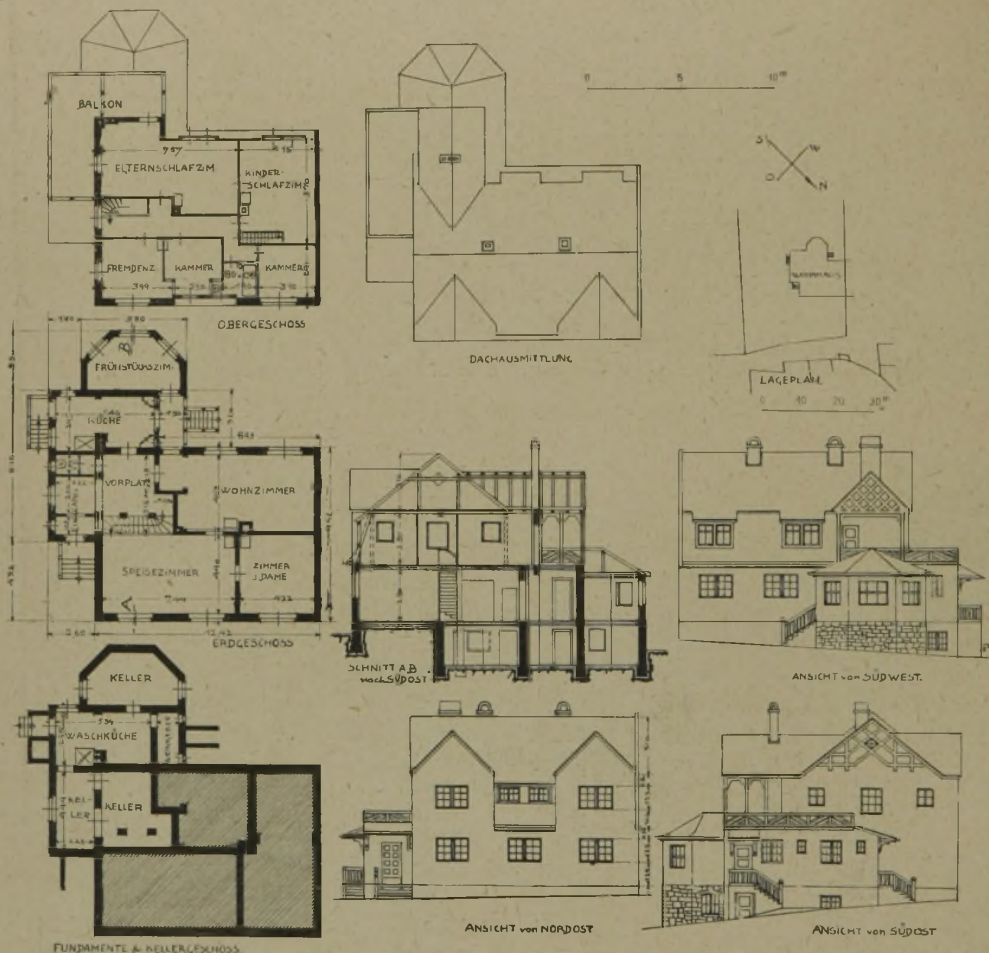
Lageplan, Grundrisse, Schnitt und Ansichten zu einem Landhaus in Altruppin.
